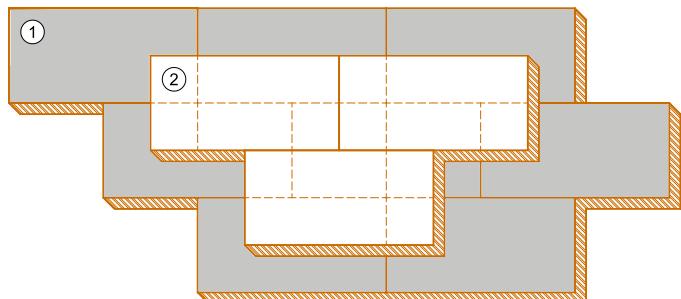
Смещение плит верхнего и нижнего слоев при укладке
